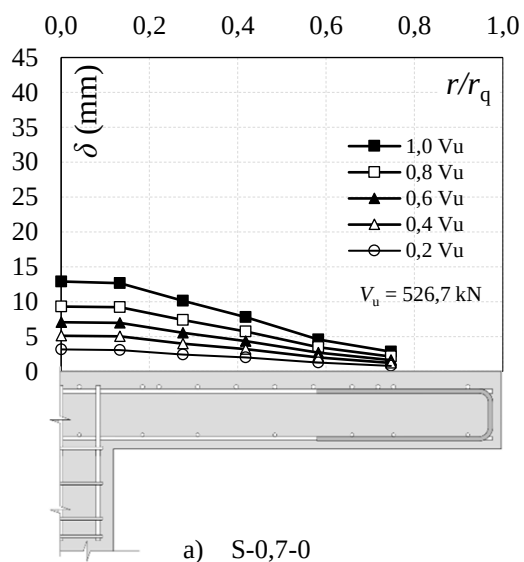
Perfil de deslocamento das lajes ensaiadas
